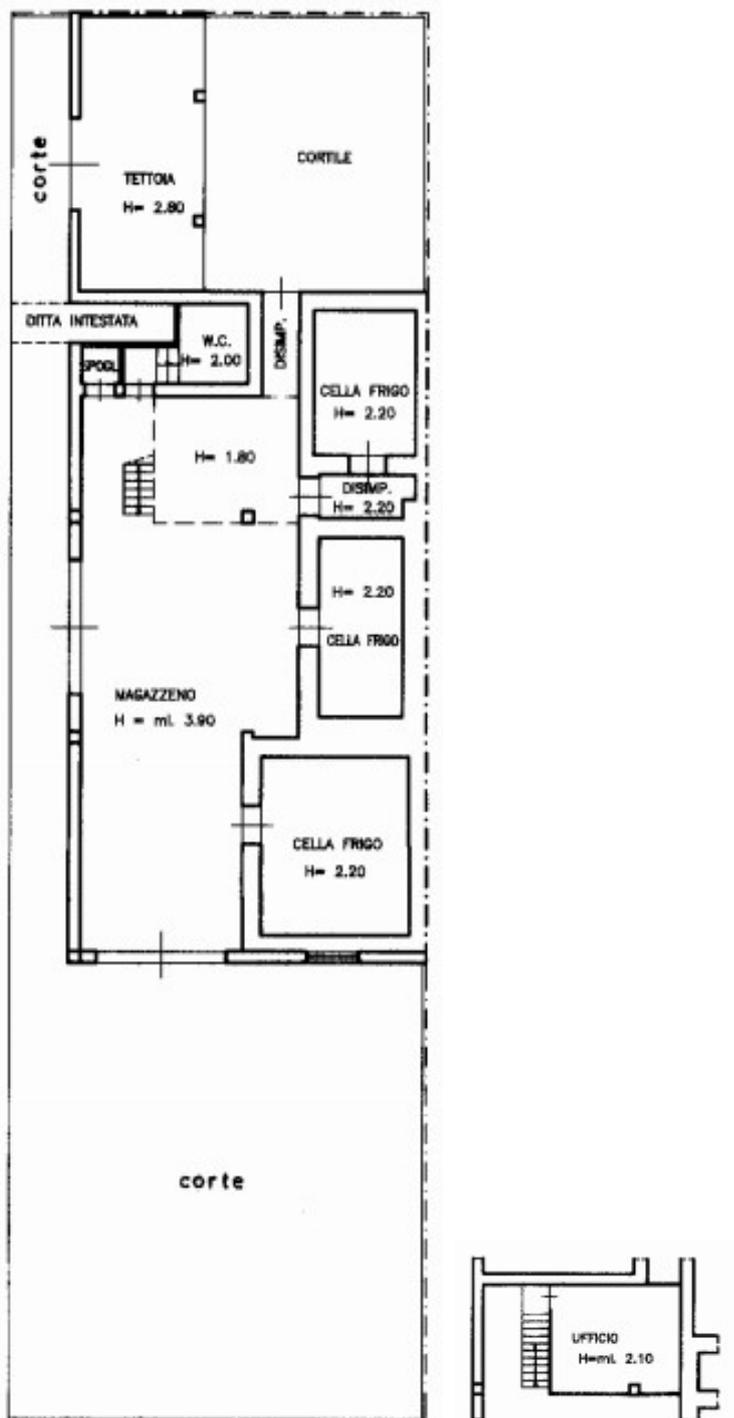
Planimetria Catastale agli atti del piano terra e soppalco
